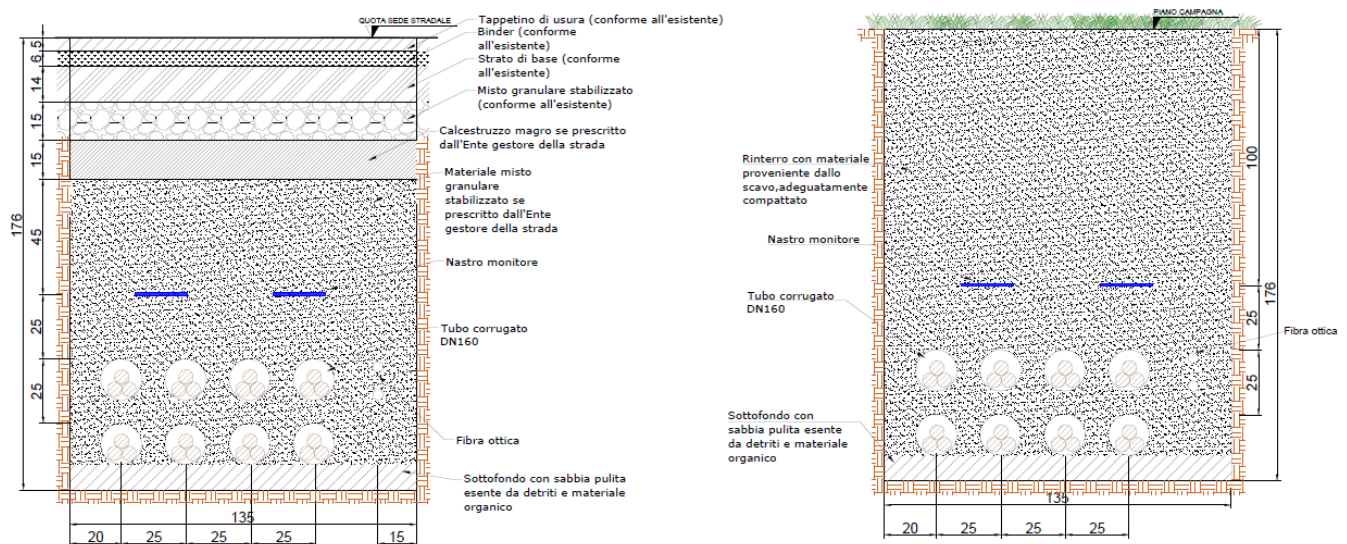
Sezione cavidotto MT su strada e su terreno
